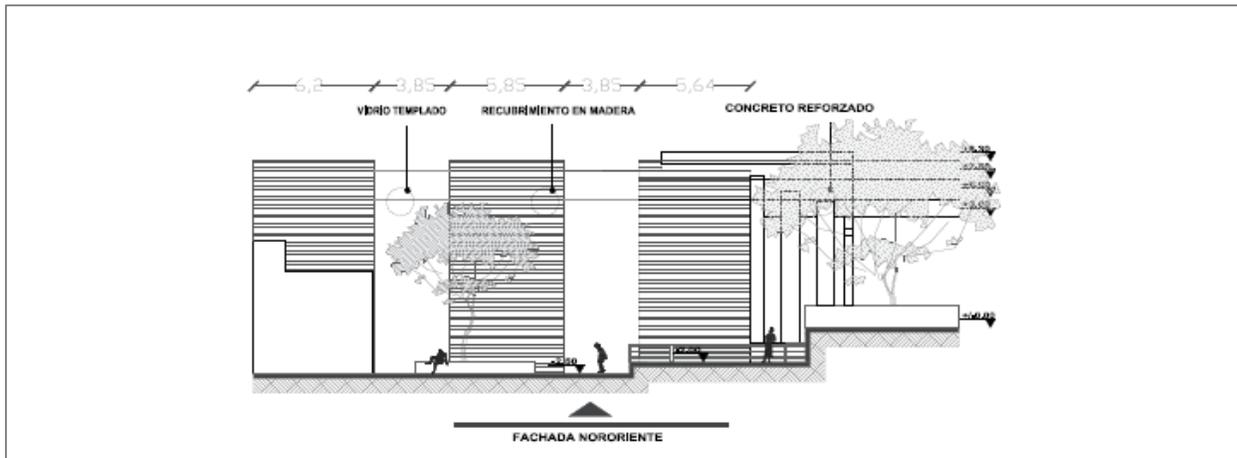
Fachada Nororiente Edificio 1 (Rubiano, 2020)
